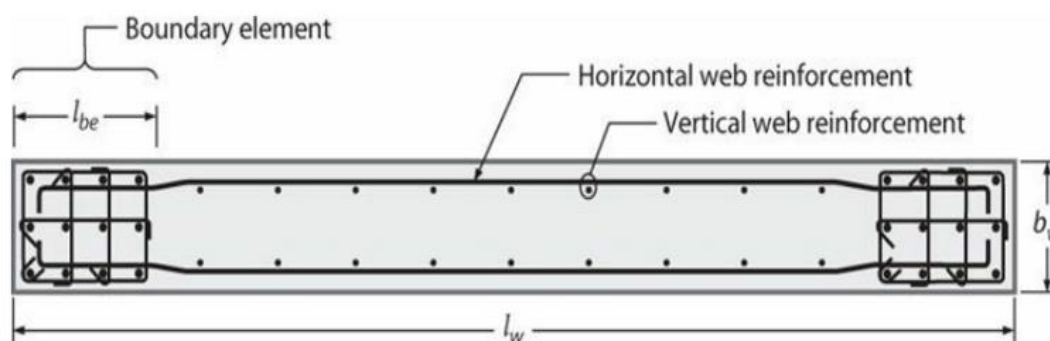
Ejemplo de refuerzo para un muro rectangular, Jack Moehle.
